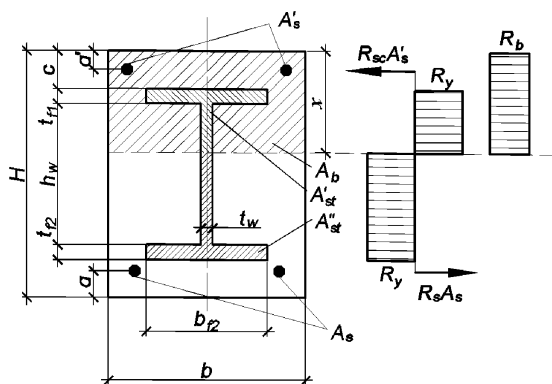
Случай, когда нейтральная ось пересекает стенку жесткой арматуры в обетонированной балке прямоугольного сечения
